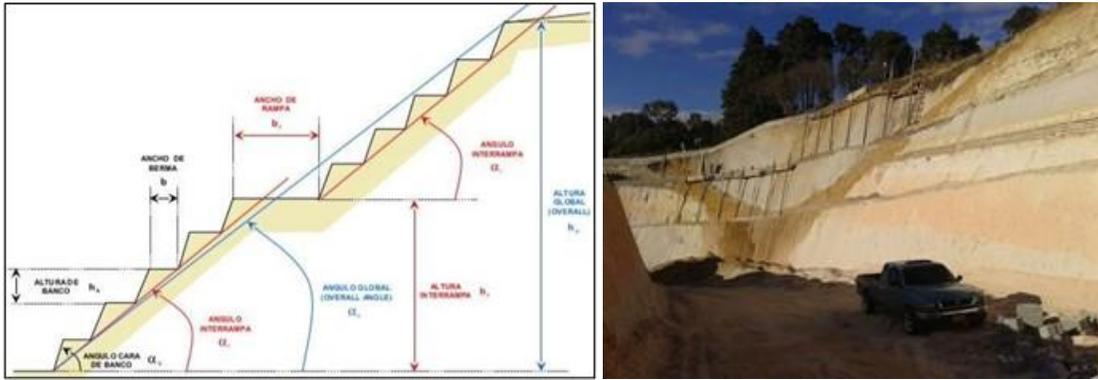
Ejemplo de diseño y construcción de escalones de liga
